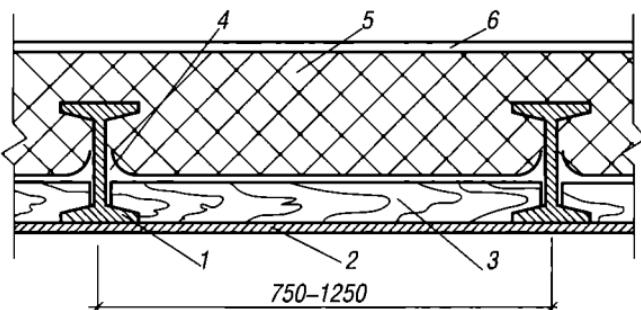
Конструкция чердачного перекрытия по стальным балкам:
